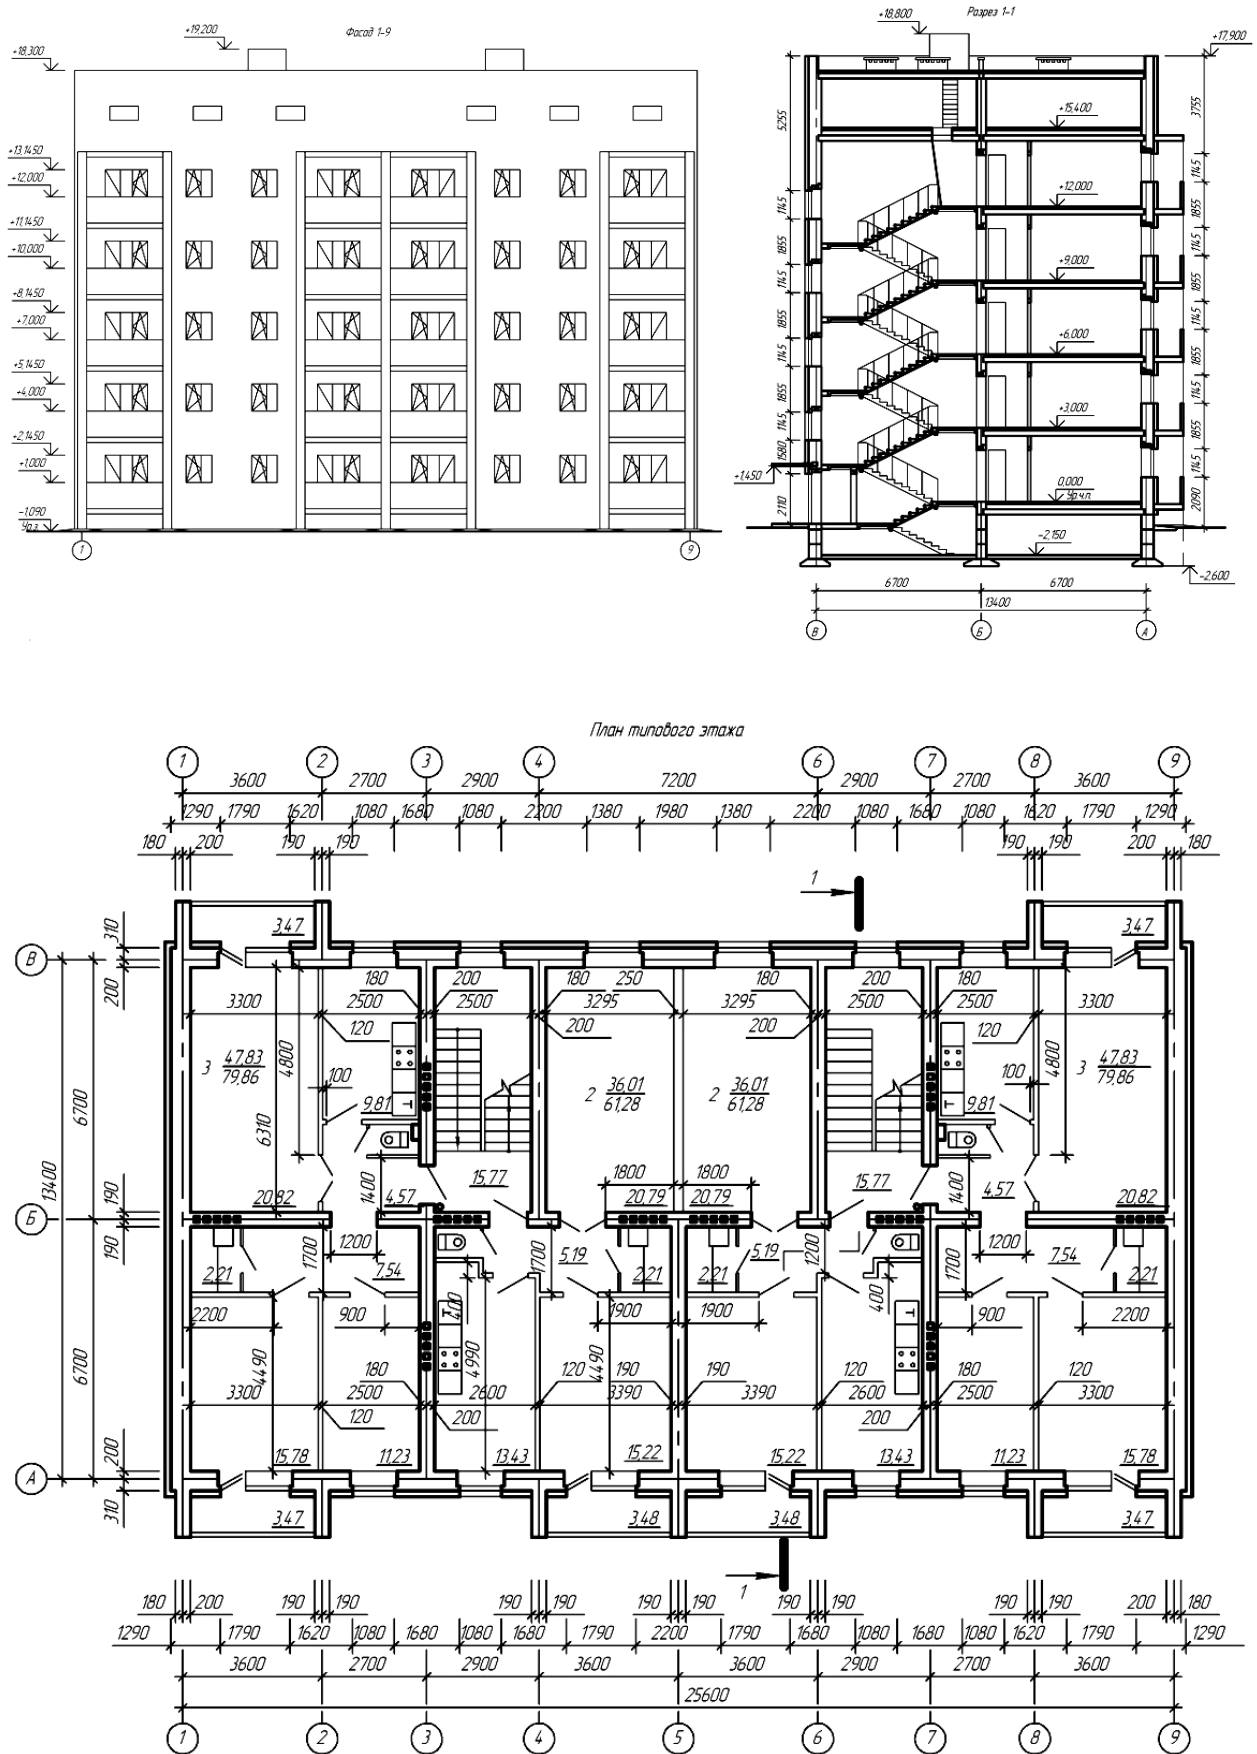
Фасад, разрез и план пятиэтажного двадцатиквартирного жилого дома. Вариант 2
